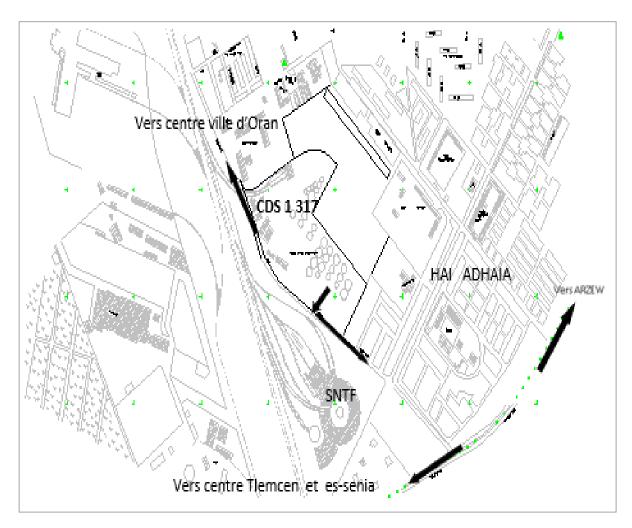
Situation Géographique de dépôt, Plan d'itinéraire
